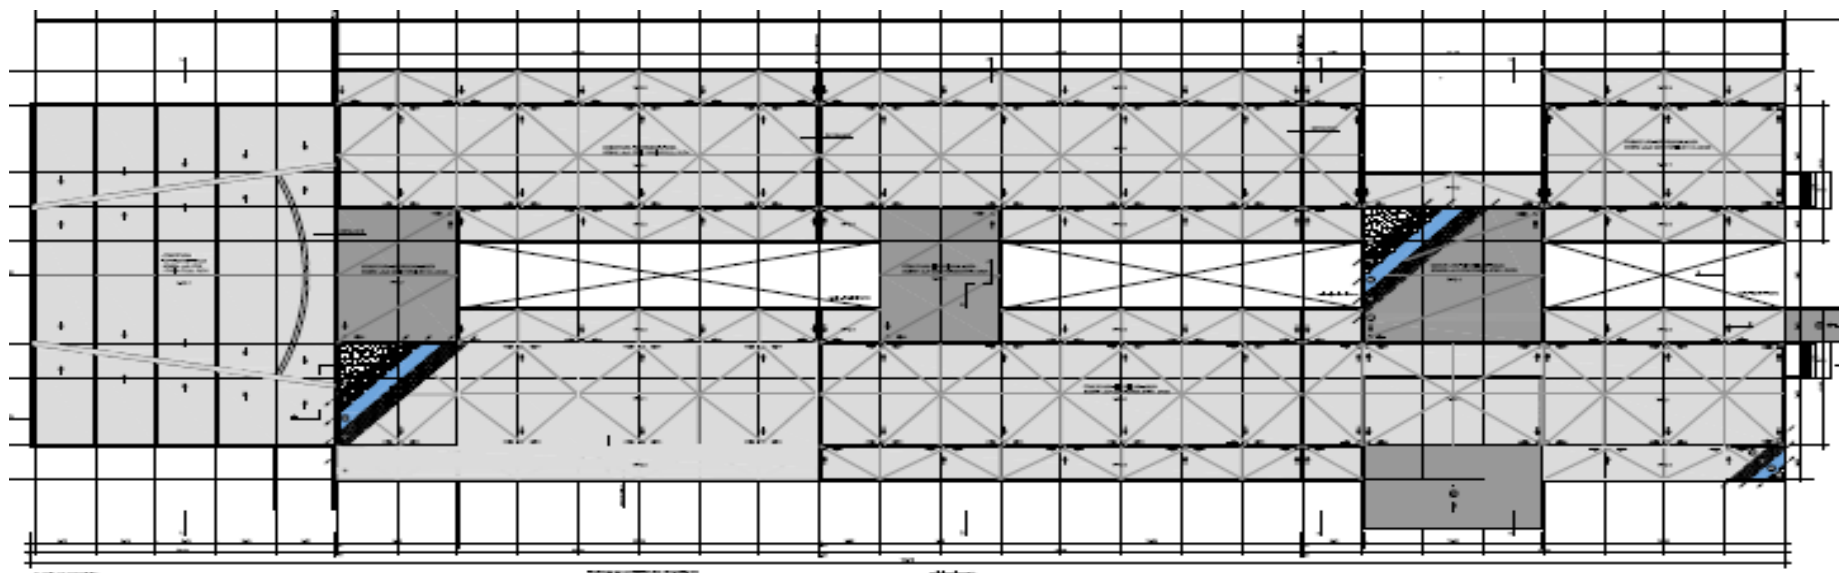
O Edifício possui 4 juntas estruturais. O pavimento da Cobertura é em estrutura mista (laje em *steel deck*, com pilares de concreto armado na junta 1, e metálicos nas demais juntas). A primeira junta abriga o auditório e a rampa de acesso. A rampa é atirantada em uma das treliças metálicas da cobertura. A estrutura do auditório é em concreto armado. As paredes do auditório sustentam a estrutura mista da cobertura (treliças metálicas e laje em *steel deck*).
